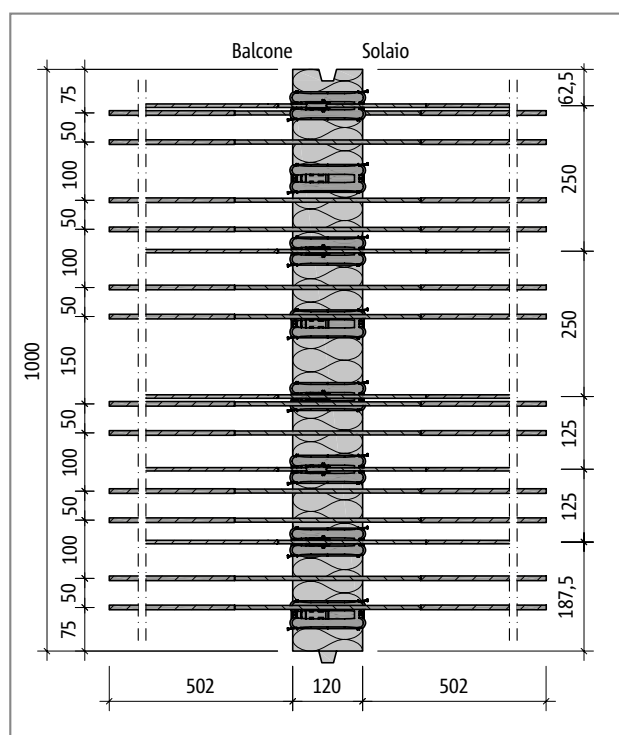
Schöck Isokorb® tipo KXT40: pianta del prodotto
